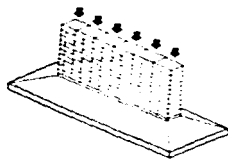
ZAPATA DE CONCRETO 1/6 MAMPONERÍA
